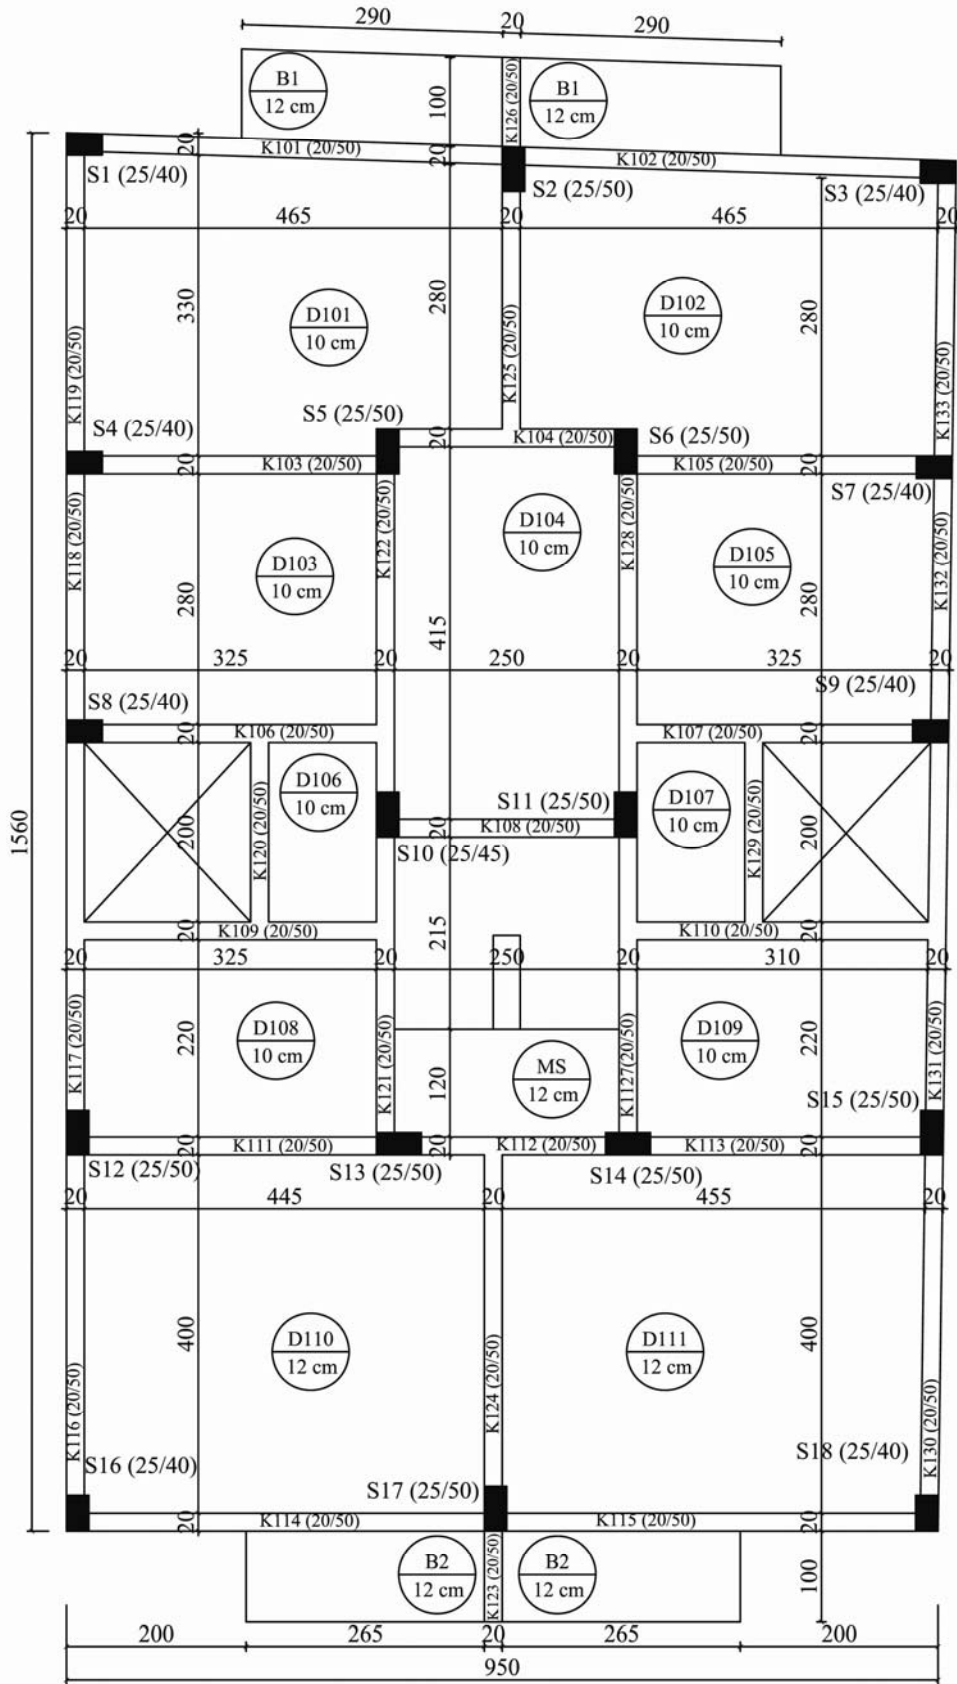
B4\_1'in kat kalıp planı
